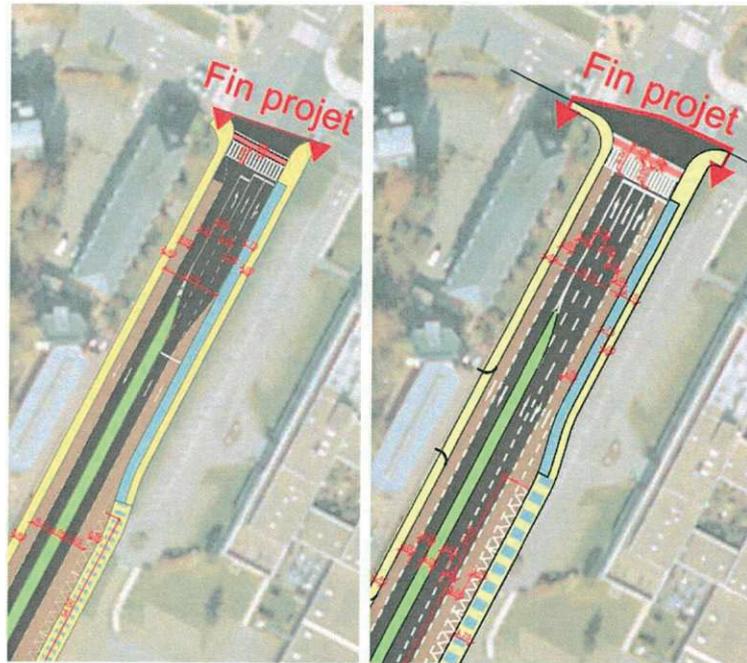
Voie bus supplémentaire réalisée sur la Route d'Esch direction Hollerich et réaménagement du parking Wort à droite
